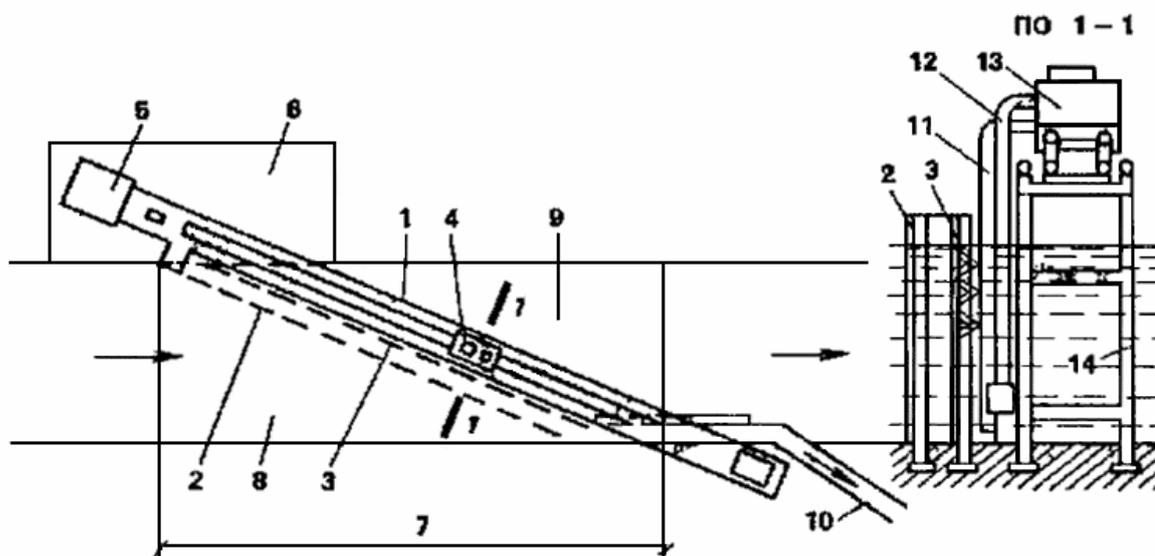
Схема расположения элементов конструкции рыбозащитного устройства типа плоской сетки с рыбоотводом
